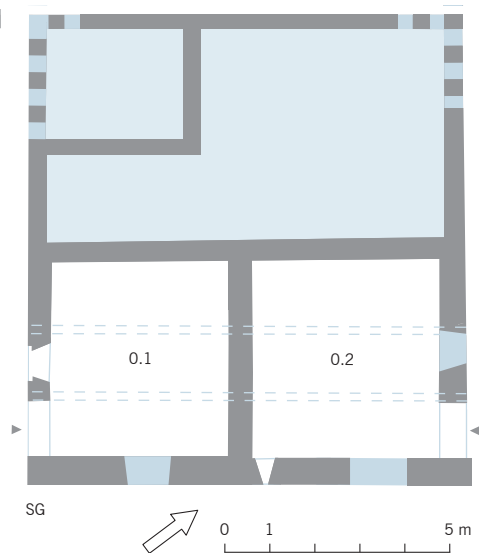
Haus Unterblacki in Unterägeri, Grundriss des Sockelgeschosses.
